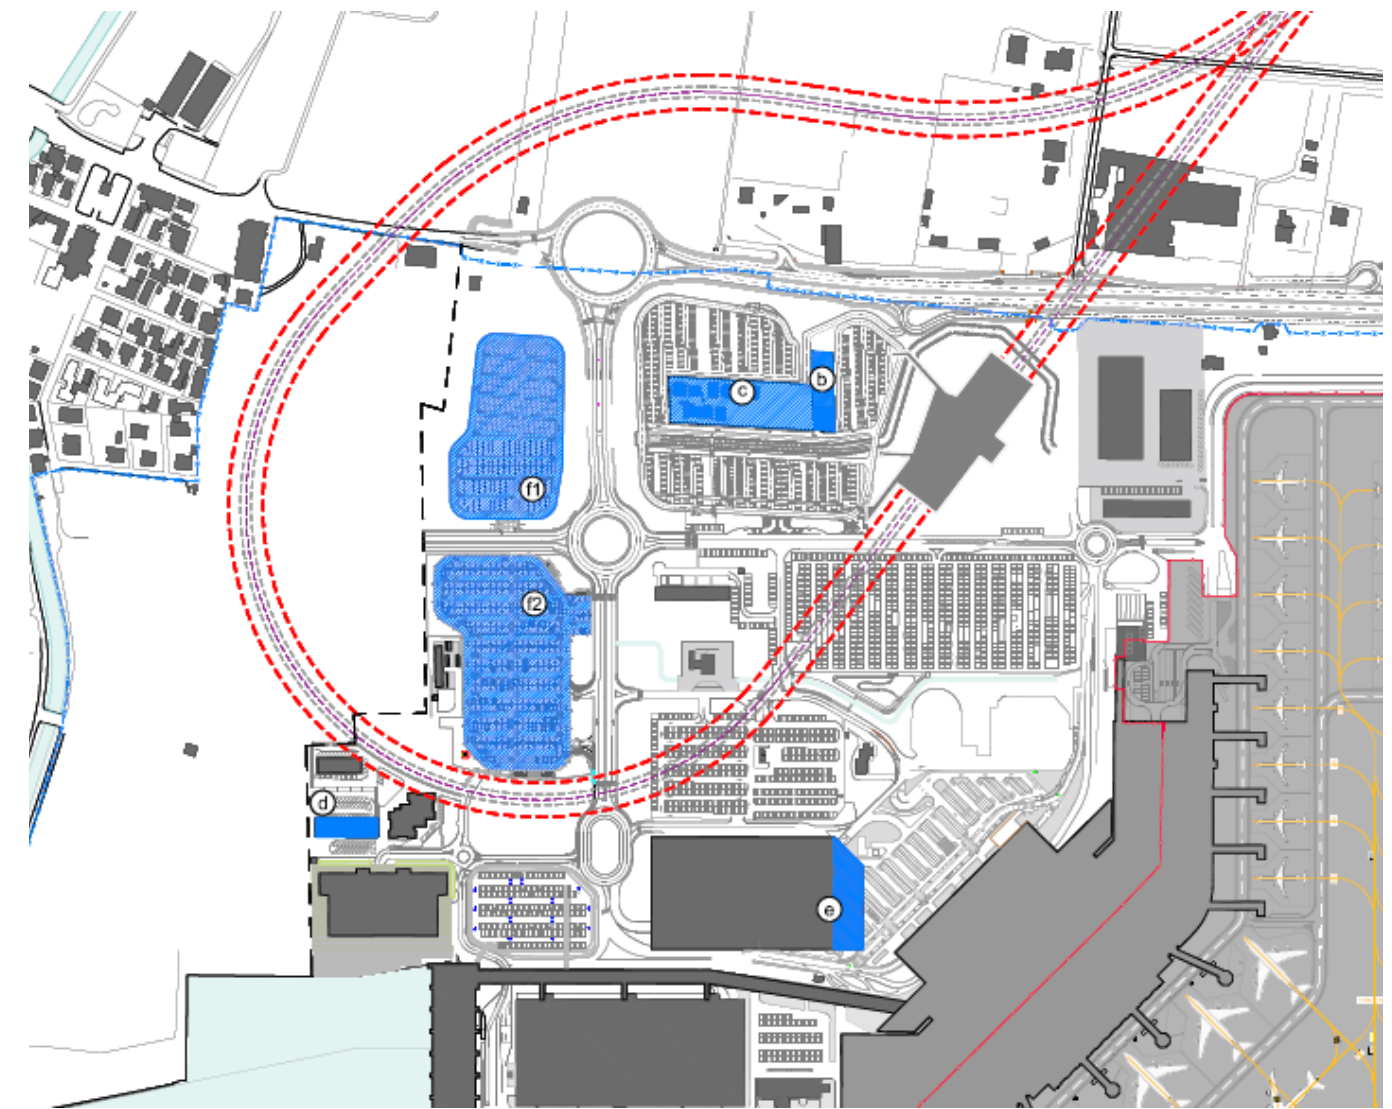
Estratto della planimetria delle riocazioni - Park P8 (f2) e P9 (f1).
